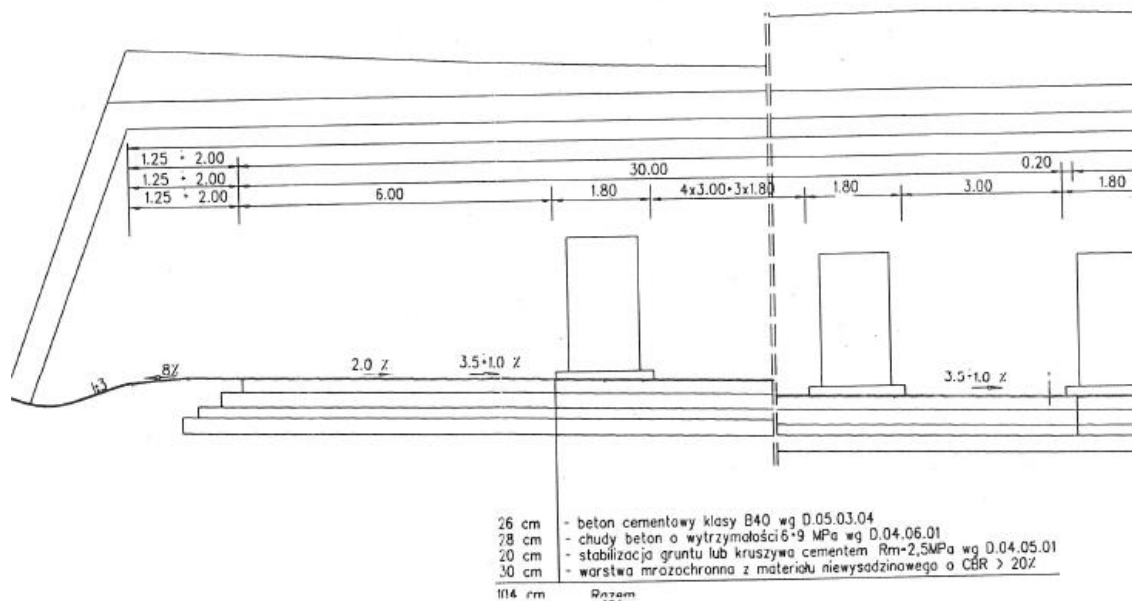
Schemat konstrukcji nawierzchni betonowej na liniach 1S, 1 i 2 w kierunku Katowic
